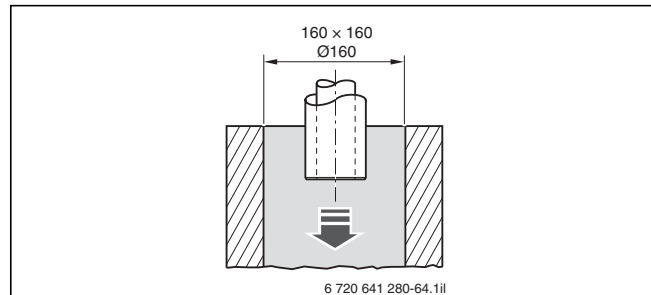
Mindestmaße des Schachtquerschnitts für die Montage der Luft-Abgas-Leitung (Maße in mm)
